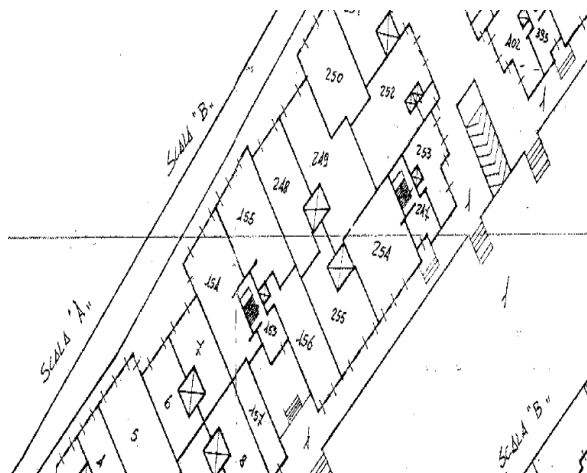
planimetria urbanistica del piano terra secondo la C.E. in sanatoria n.14/2000 del 19/10/2001
